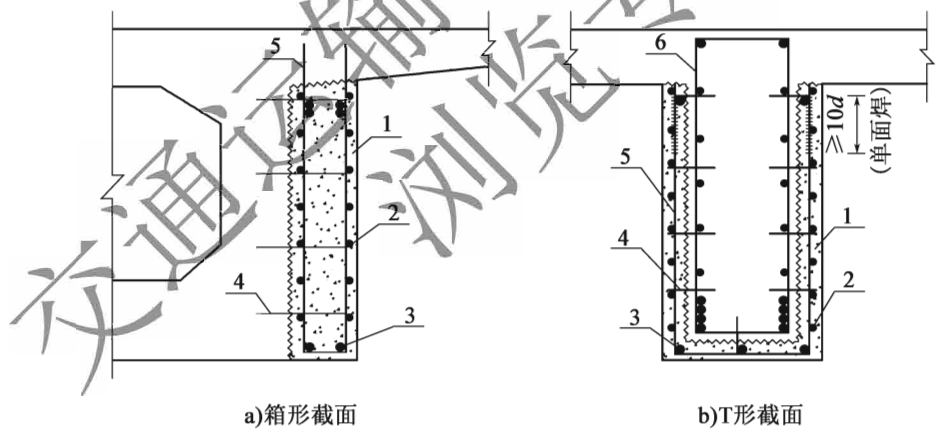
受弯构件新增抗剪钢筋连接构造示意
